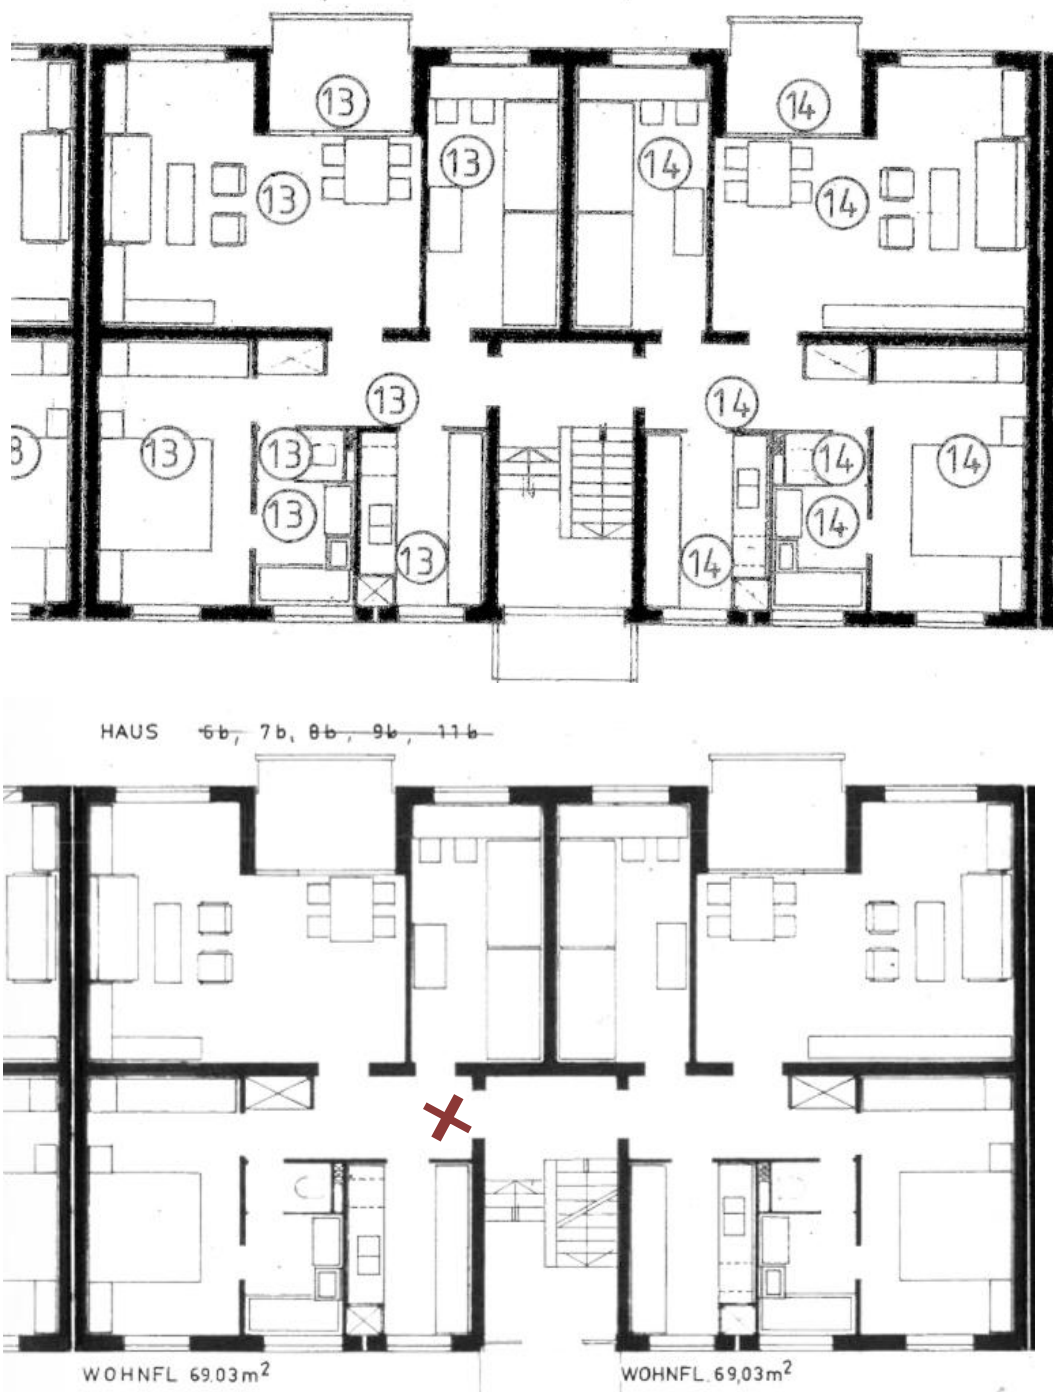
Grundriss der Wohnung (mit Flächenangaben / Teilungsplan)
